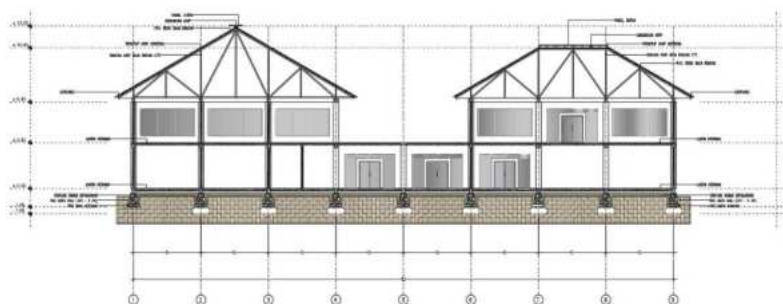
24 Konsep Struktur Dan Konstruksi Pada Bangunan Villa Tipe 3
